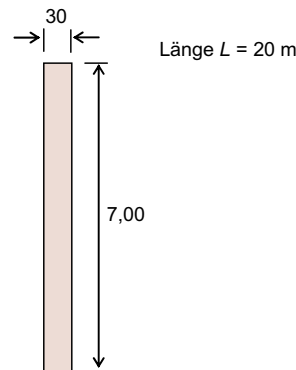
Beispiel: Frischbetondruck auf eine Wandschalung
